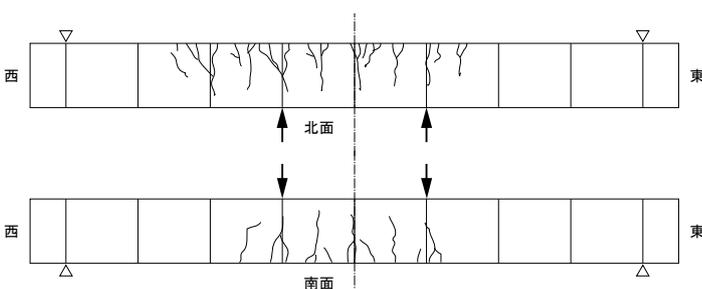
試験体 No.1 ひび割れ状況 (梁曲げ試験)
